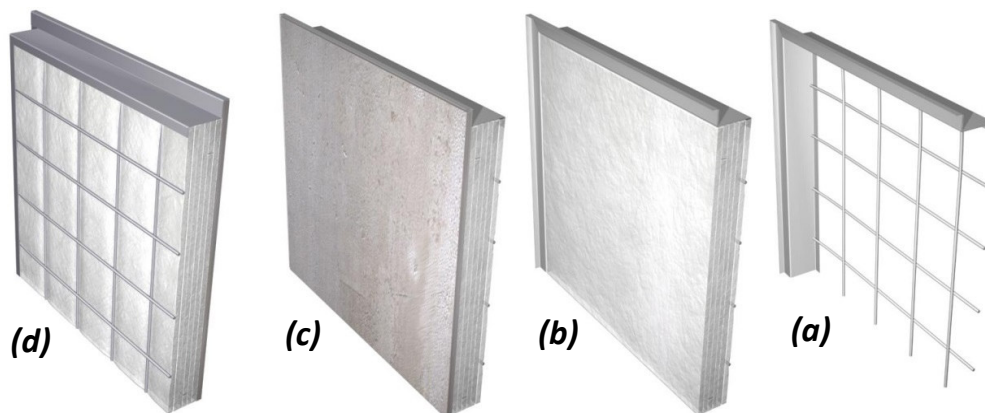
Da direita para a esquerda a sequência de montagem de um quadro de revestimento externo típico: (a) a moldura é formada com quatro perfis de chapa dobrada de aço carbono cortados a 45° soldados nos cantos e depois a tela é soldada na face interna da aba posterior, (b) o isolamento já cortado é encaixado no quadro, (c) a vedação é colada na aba da frente e (d) vista posterior do quadro pronto.
